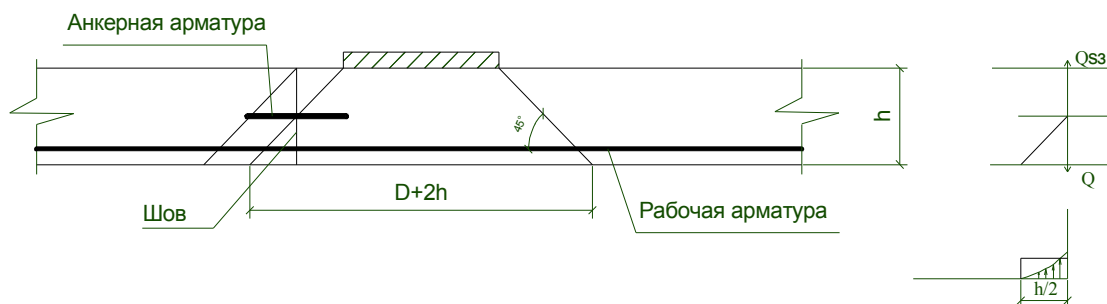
Схема распределения нагрузки для плит жесткого дорожного покрытия
